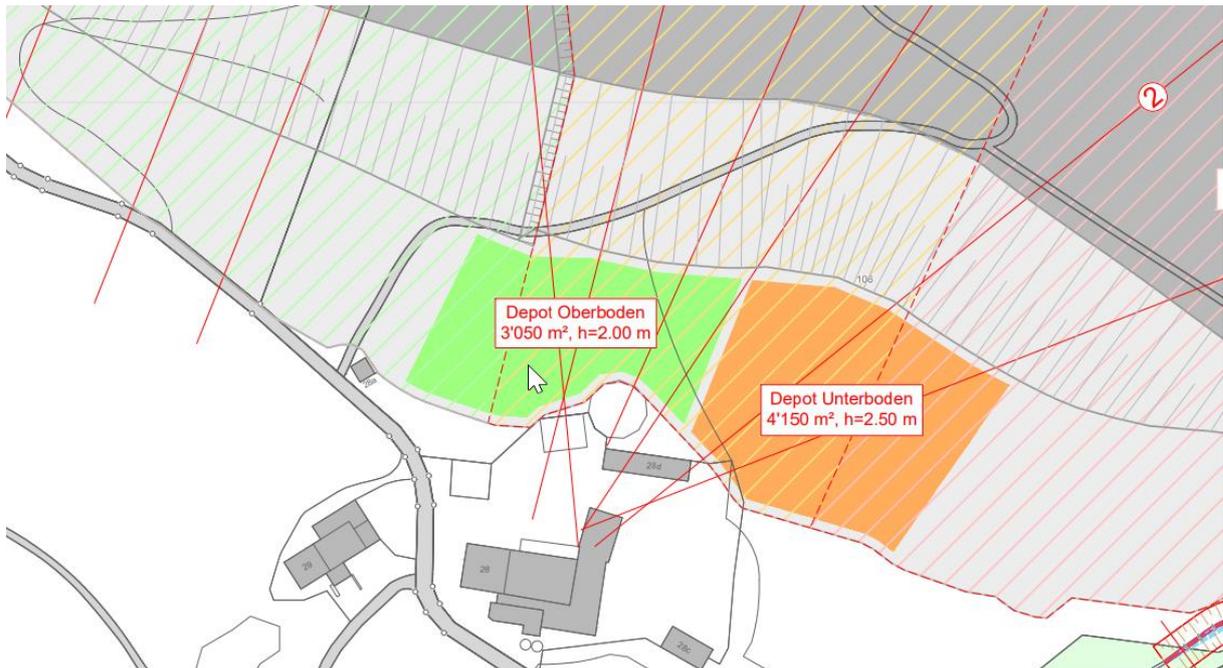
Lage der geplanten Bodendepots, Beilage Vorprojekt, TAGMAR AG, Plan-Nr. 17-026-301 vom 28.2.2024
